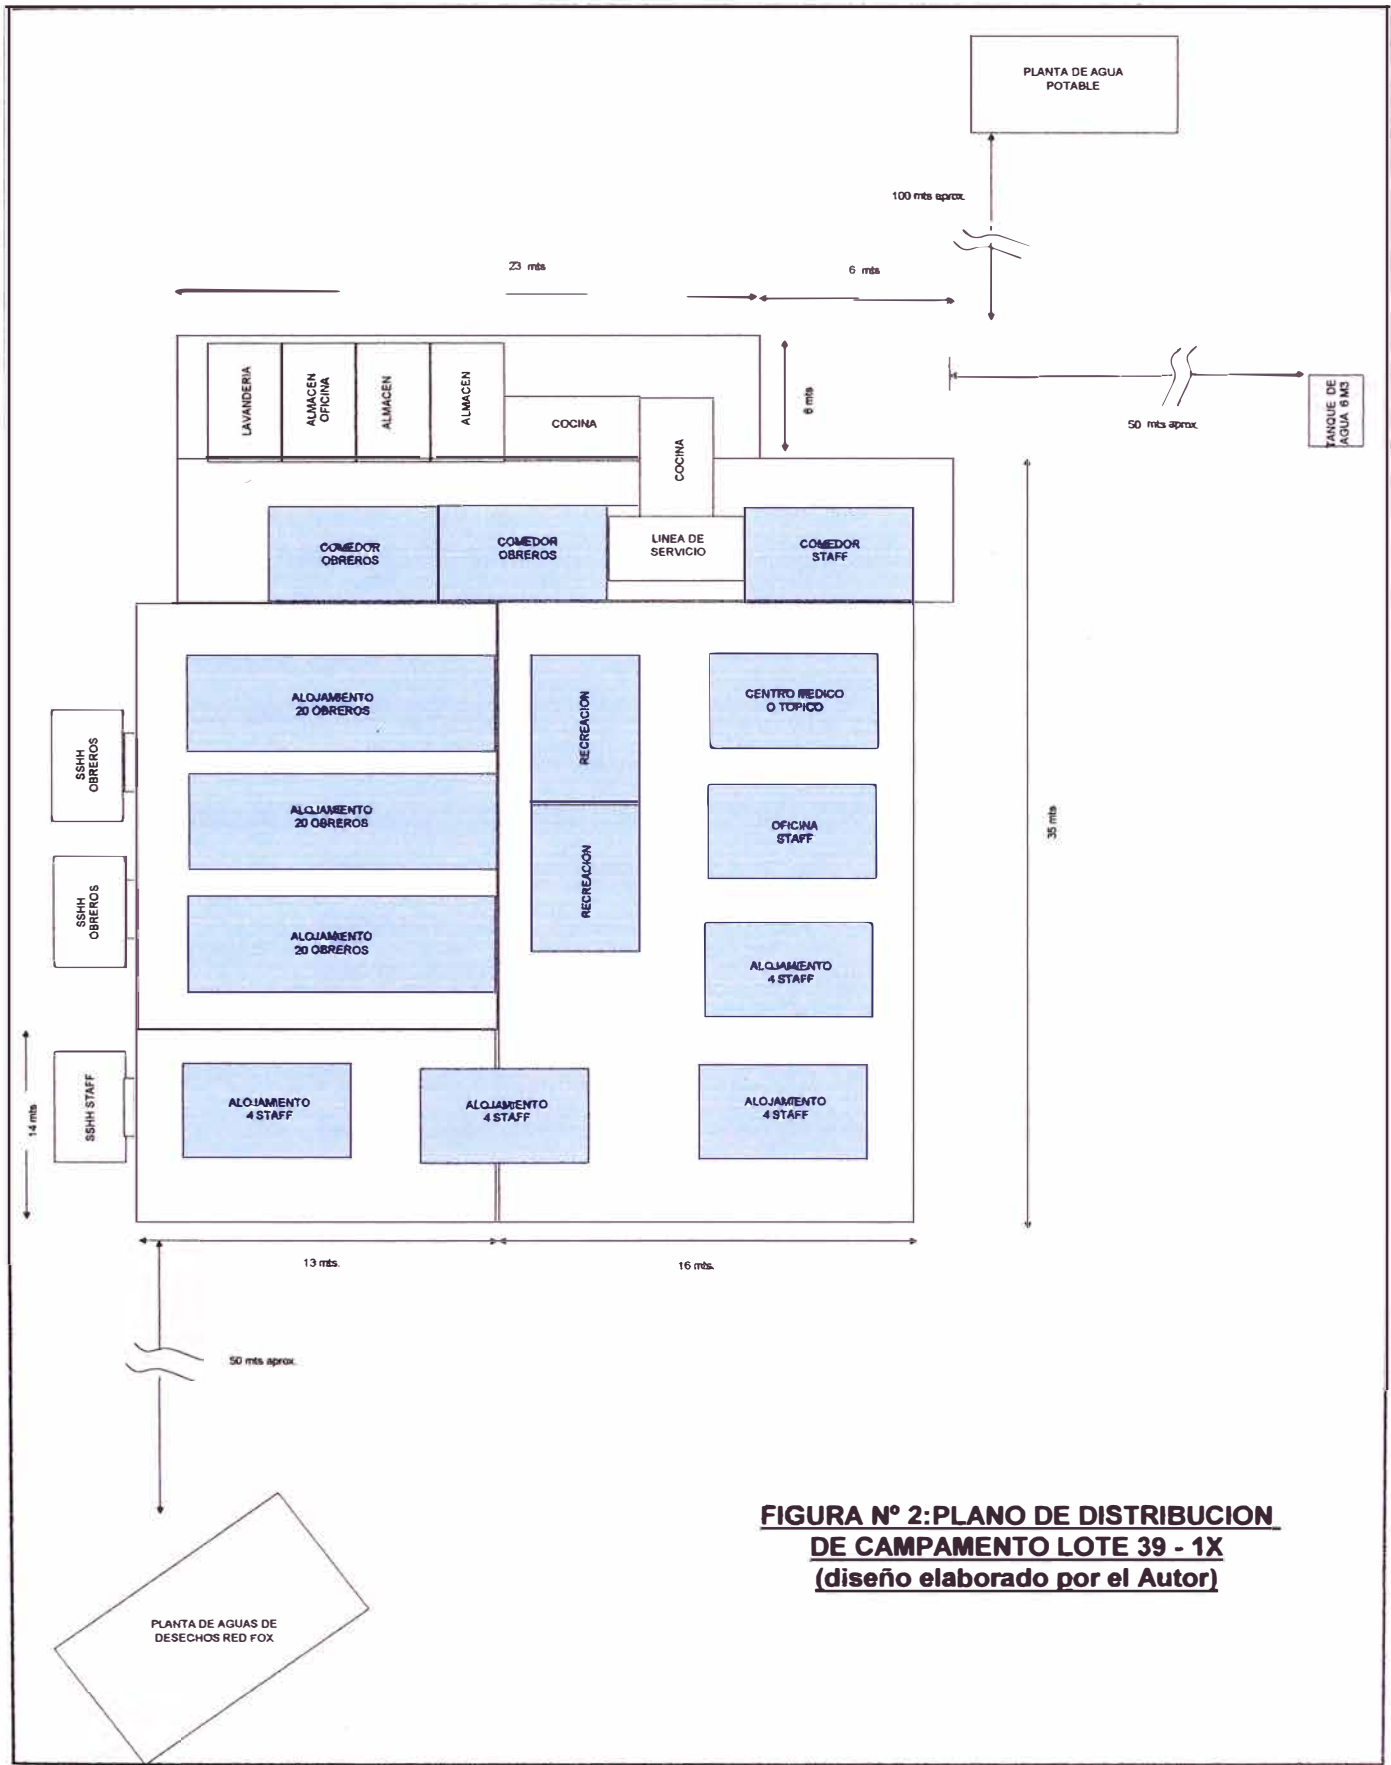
PLANO DE DISTRIBUCION DE CAMPAMENTO LOTE 39 - 1X (diseño elaborado por el Autor)
